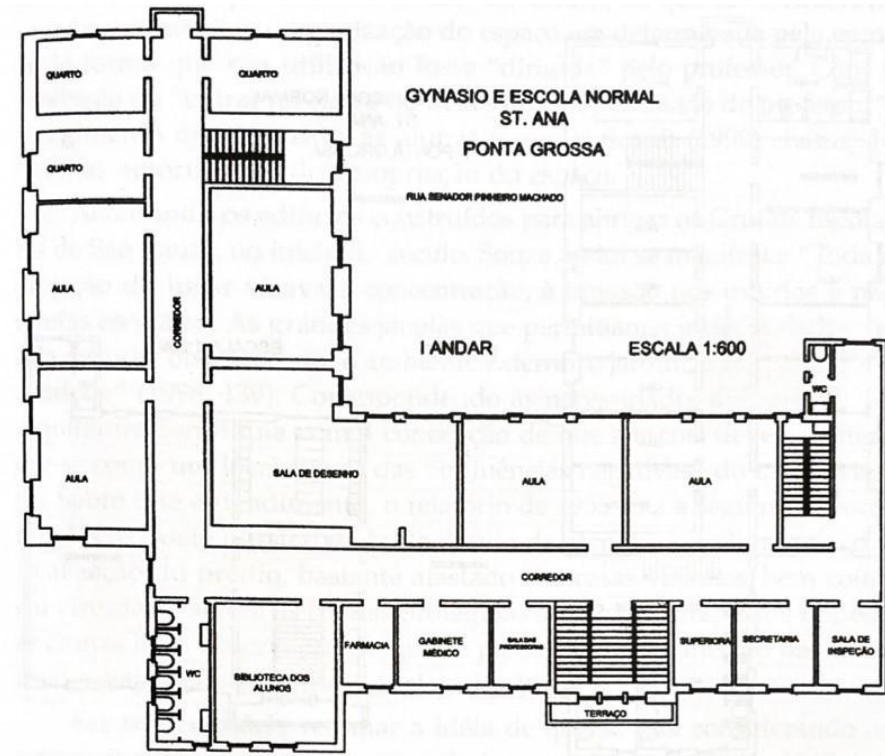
Planta do primeiro pavimento. Fonte: CHORNOBAI, 2005.
